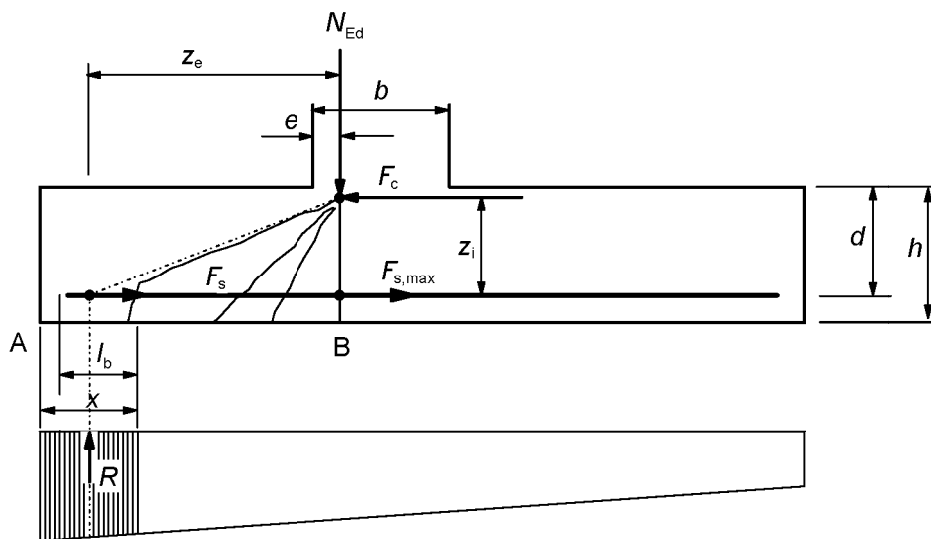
Modelo para la fuerza de tracción en relación con las fisuras inclinadas
